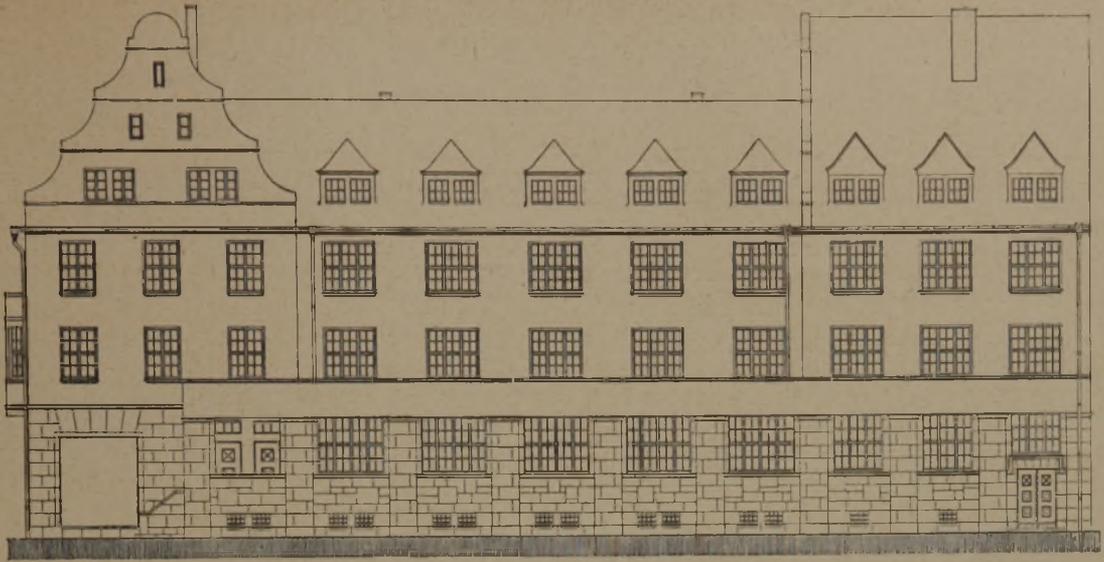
Fassade an der Juristenstraße. (1 : 300.)
